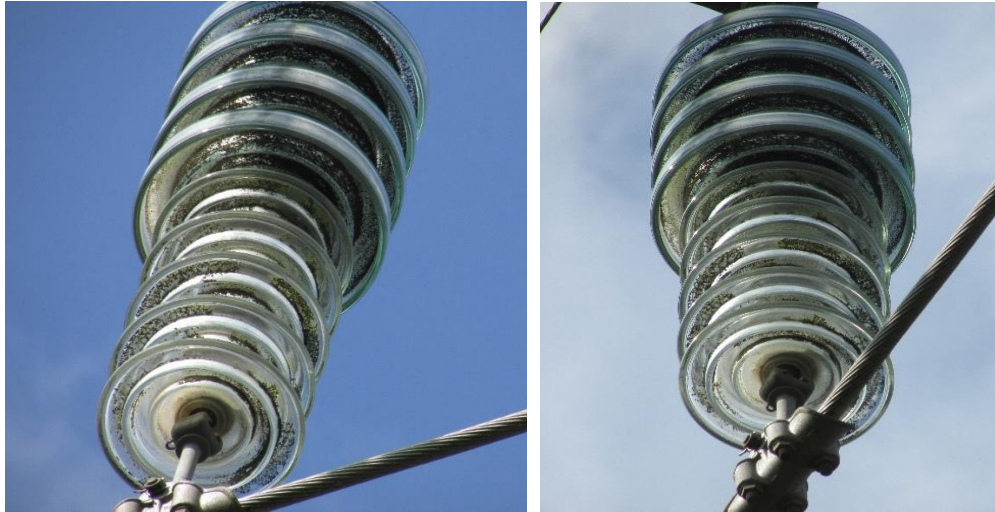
Estructura número 71 aislamientos de vidrio contaminados en fase A, B Y C.
